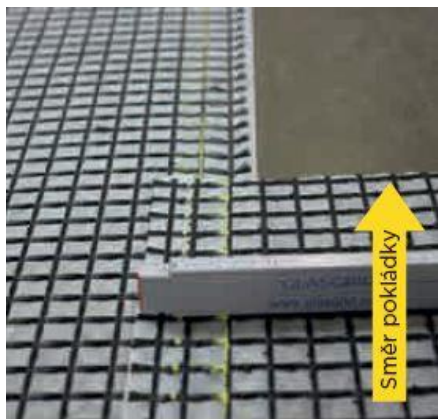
Instalace geomříže – strojně, zdroj: [14]
